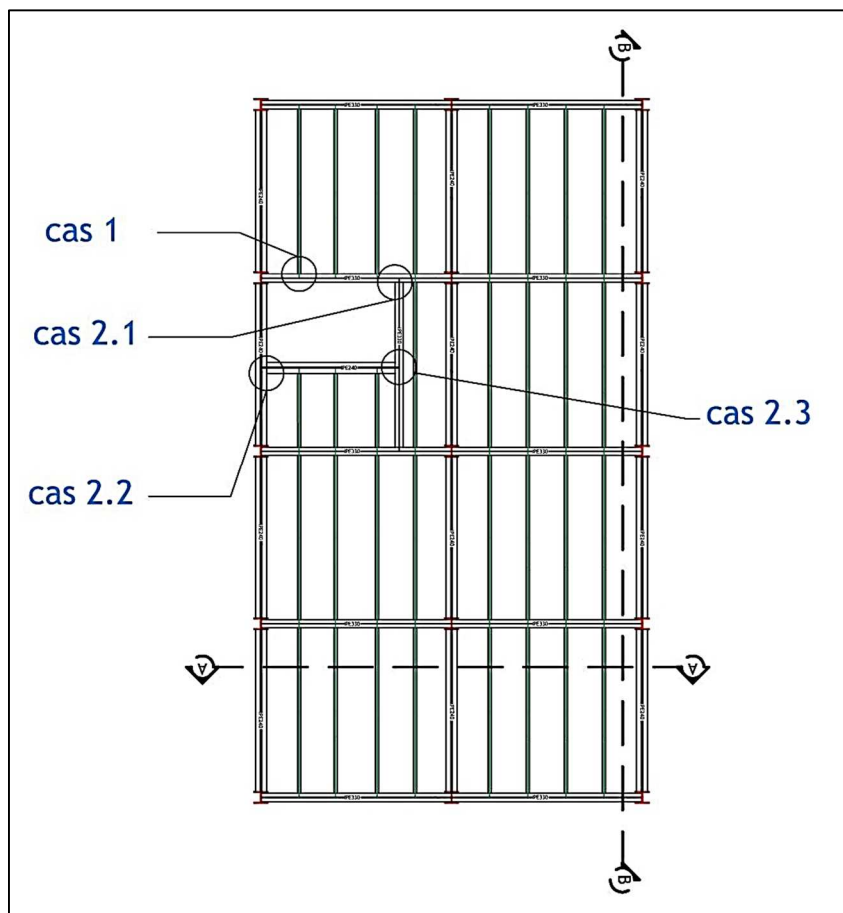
Plan du 1<sup>er</sup> étage de la disposition des éléments
